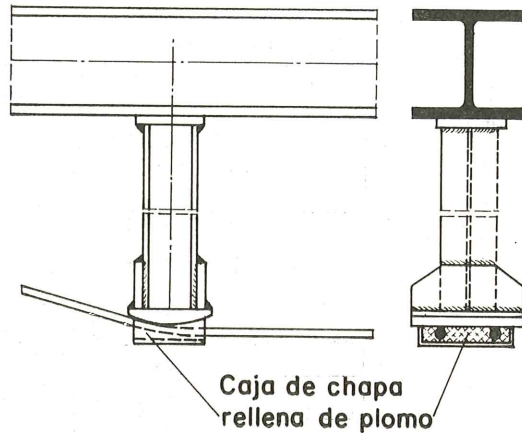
Dispositivo de cambio de dirección, de armaduras de pretensar, exentas.
